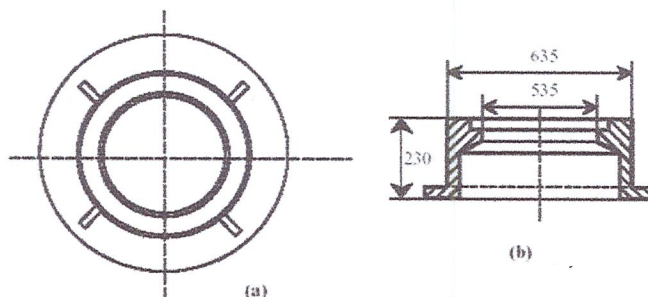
Armaduras de pozos de inspección. (a) Planta; (b) sección de armadura pesada
